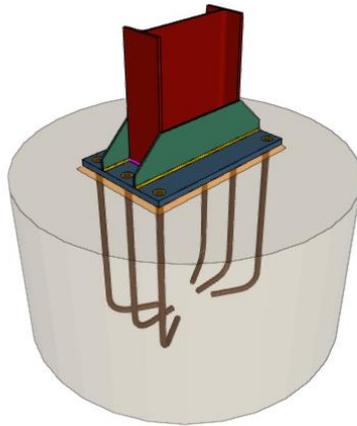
Vista unión pilar-cimentación pórticos intermedios
